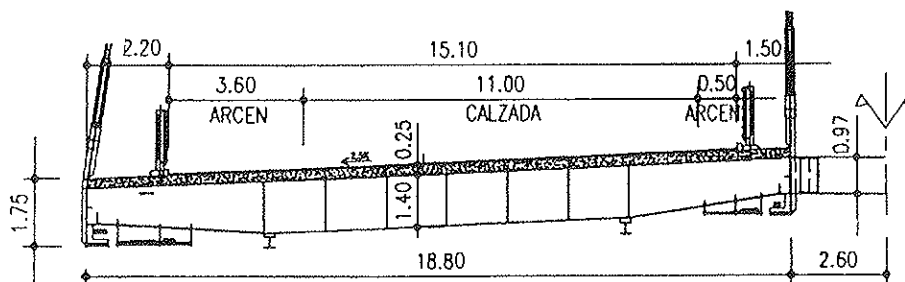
Puente Atirantado. Sección transversal típica del tablero.
